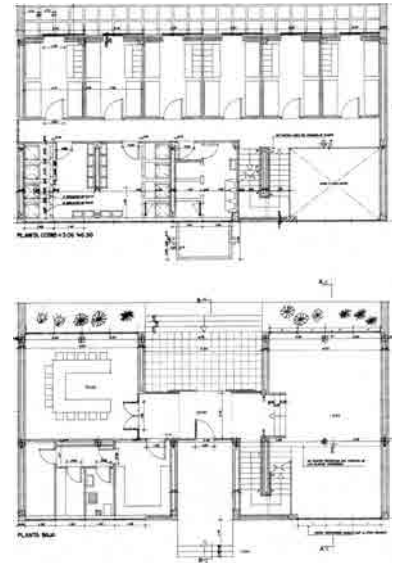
y Fig. 101 Residencias del Centro de Universidades Laborales de Málaga. Planta tipo (arriba) y planta baja (abajo) de uno de los bloques.
